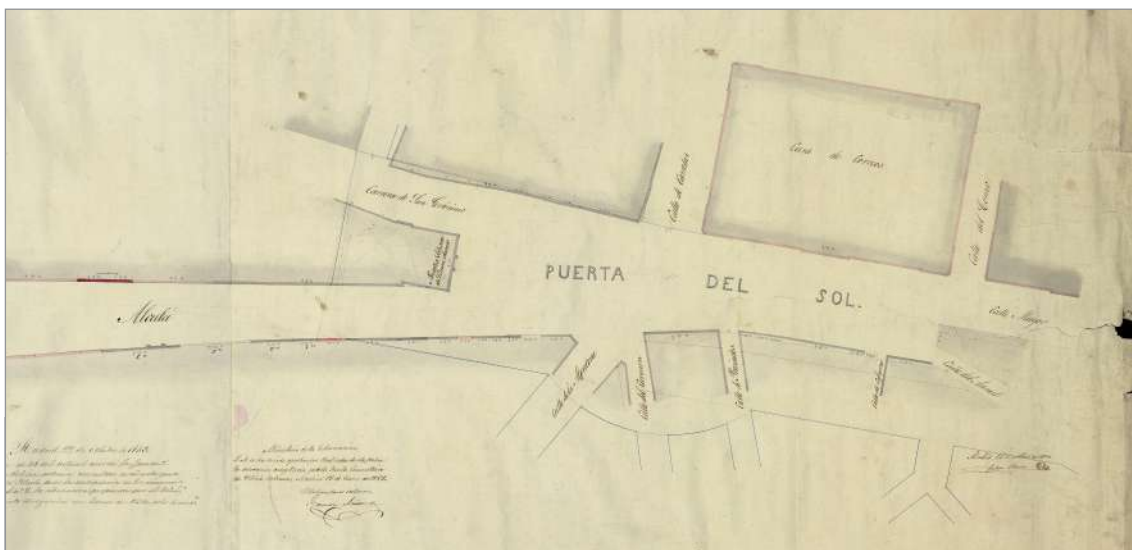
Plano de proyecto de alineación de fachadas en la Puerta del Sol (1853) Archivo de Villa, 0,69-11-5.
